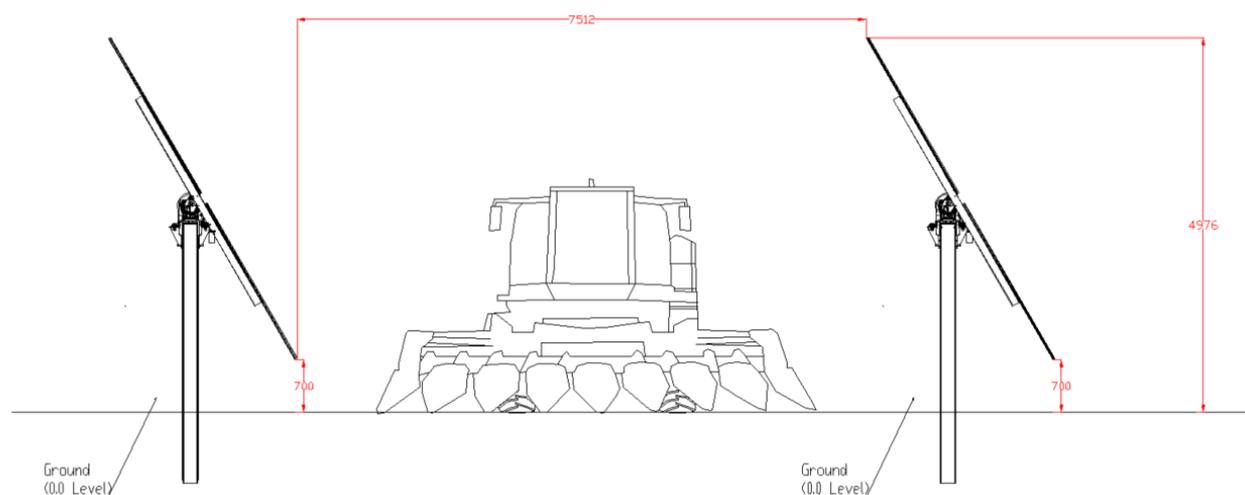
Dettaglio dell'altezza massima e minima raggiunta dai tracker.
